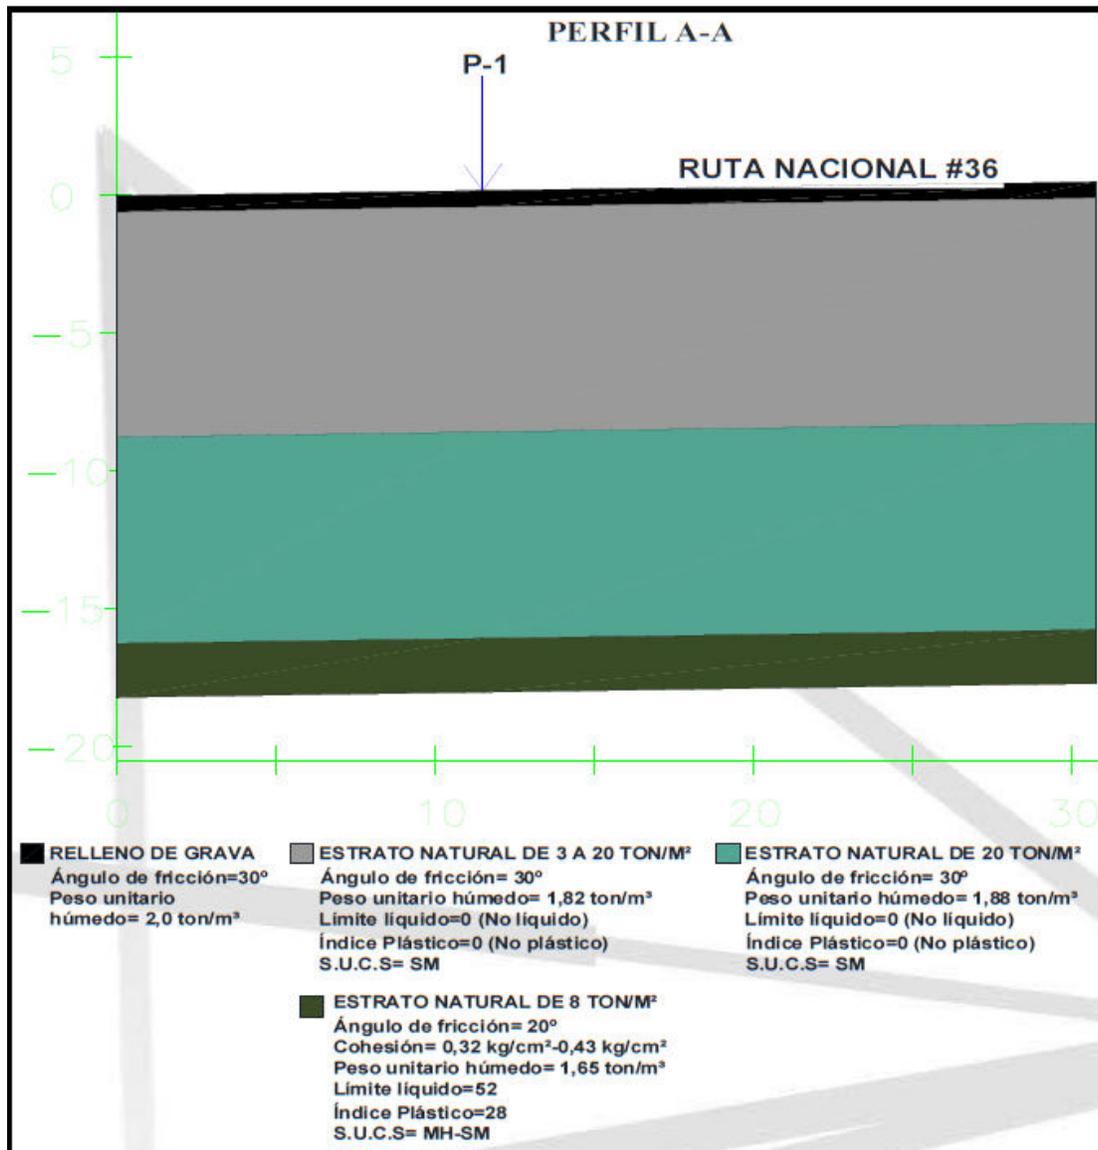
Perfil estratigráfico del sitio Alcantarilla Norte.
